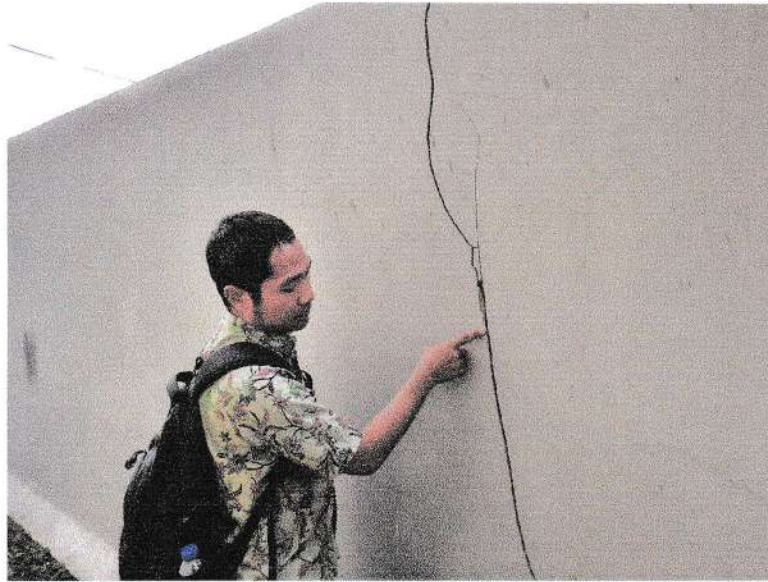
Retakan pada tembok rumah warga yang terdampak bencana di RT 4 RW 9.
